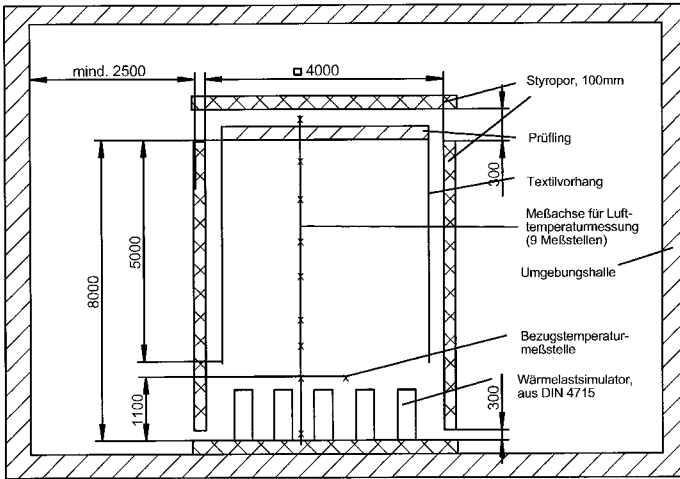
Versuchsaufbau im hohen Prüfstand mit Einbauhöhe 8 m
